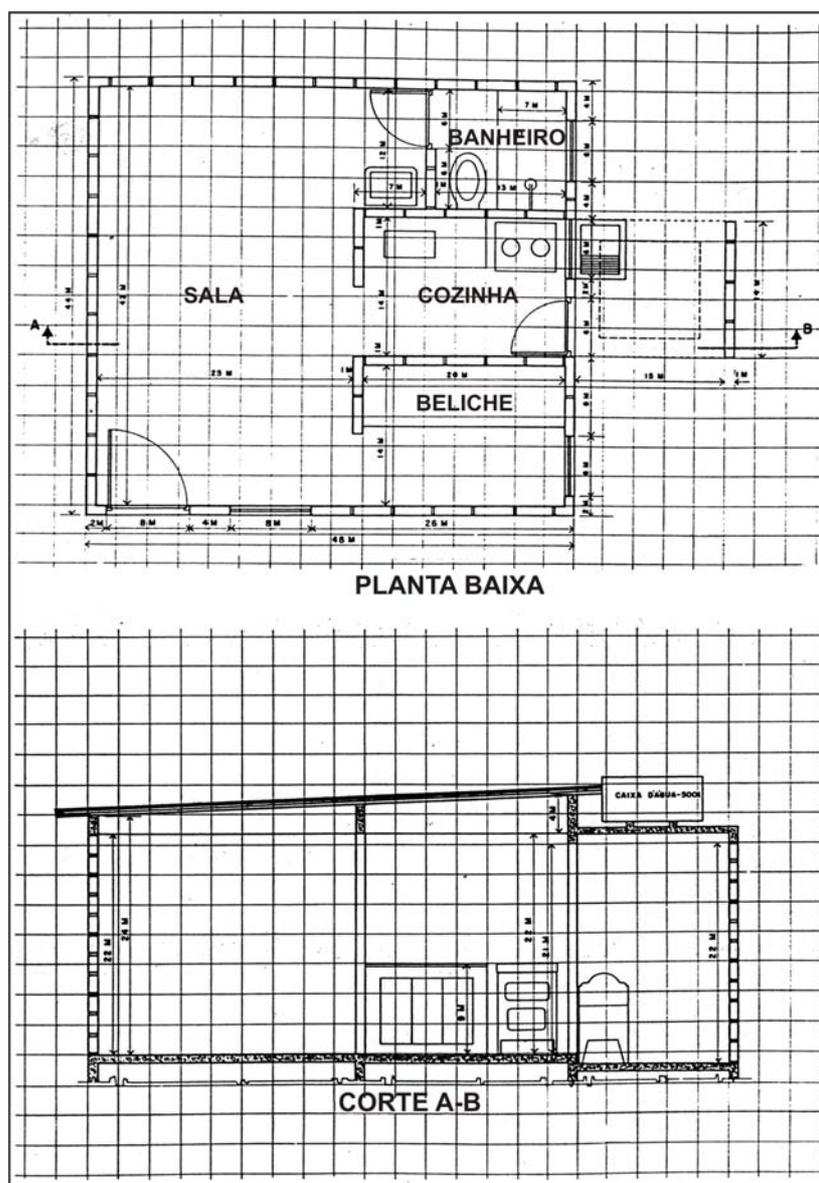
Planta Baixa e Corte A-B, exemplo de estudo em 1967
